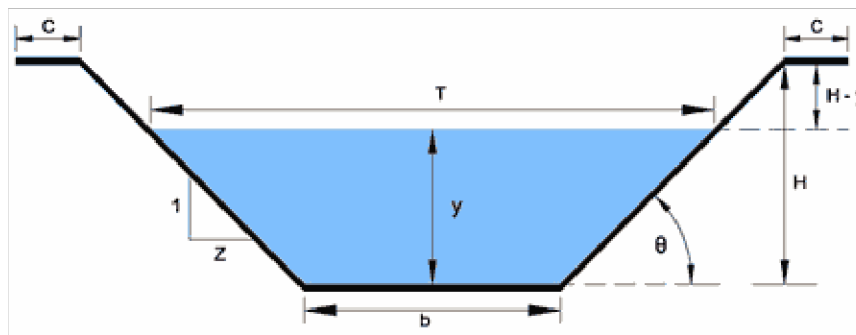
Elementos de una sección de canal trapezoidal. [18]
